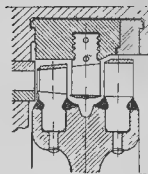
Крепление лопаток двухвального диска сваркой.
